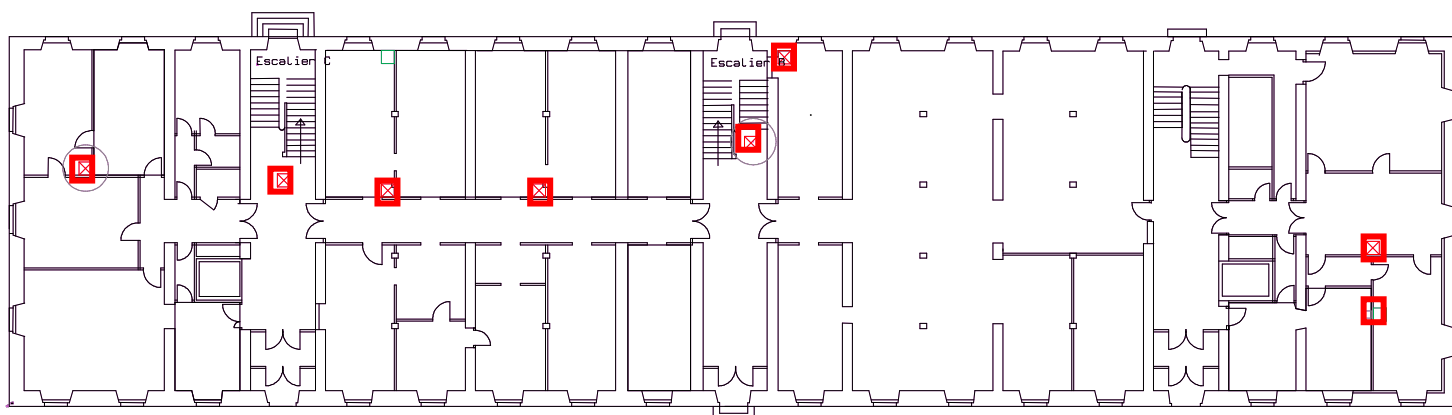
Vue en plan – Niveau Plancher haut Rez-de-chaussée
